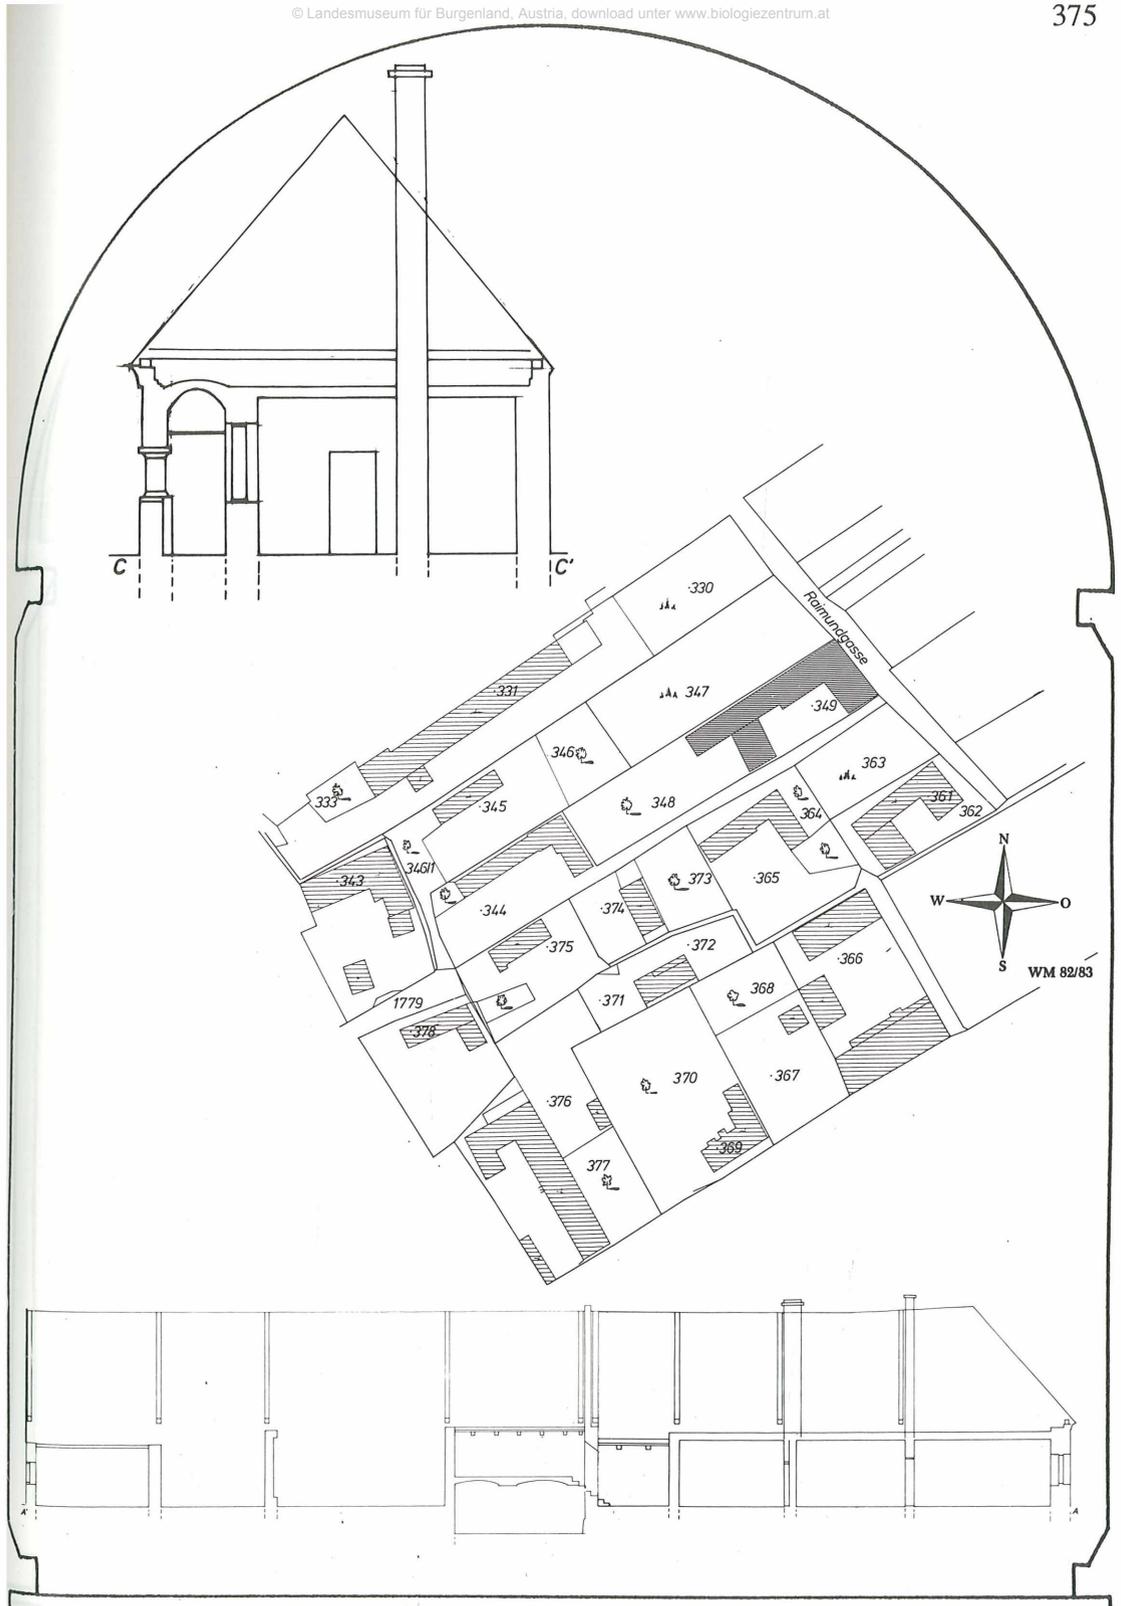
Oberwart, Raimundgasse 21 - Schnitte, Details und Lageplan
